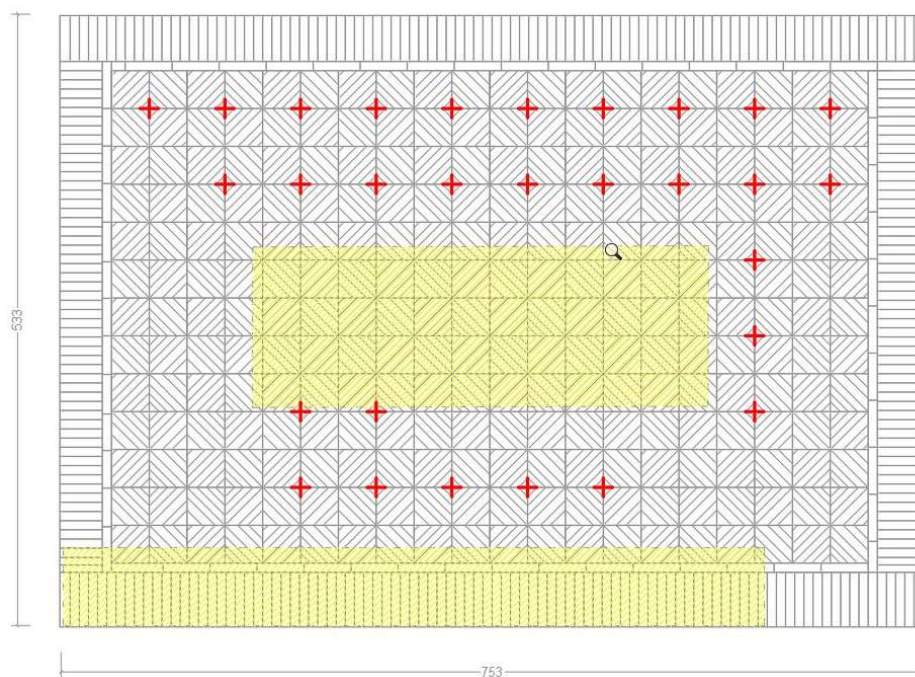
Camera di Consiglio: mappatura della pavimentazione deformata
